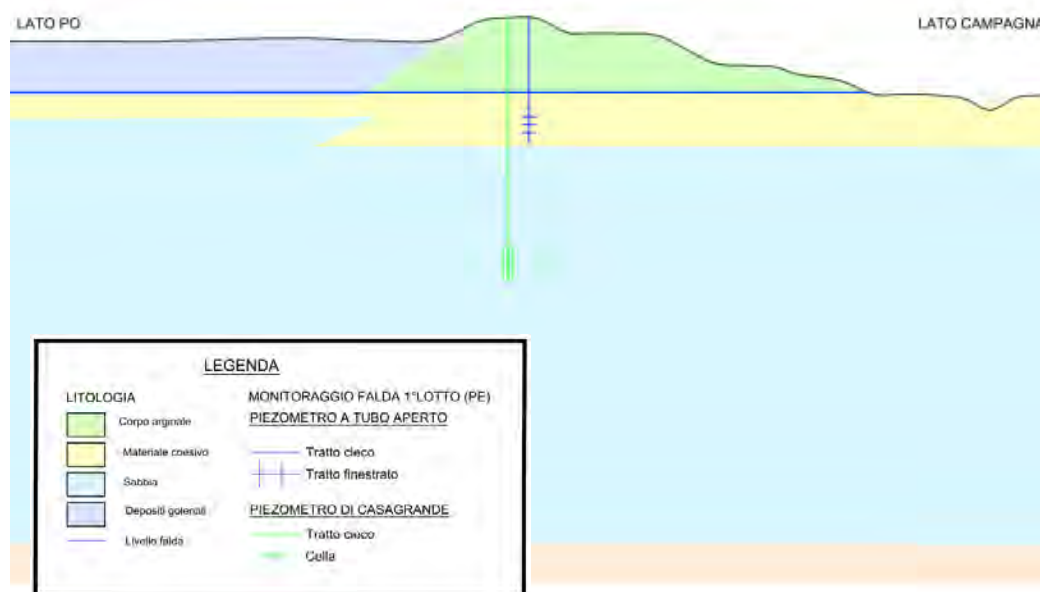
Stralcio ubicazione piezometri lungo sezione trasversale
